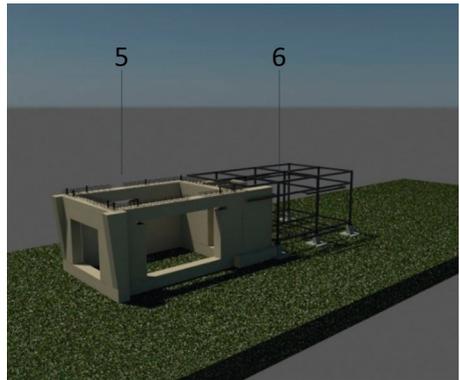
Proceso 4: construcción muro de tapia y nivelación para instalación de viga superior de cubierta o mezanine.
